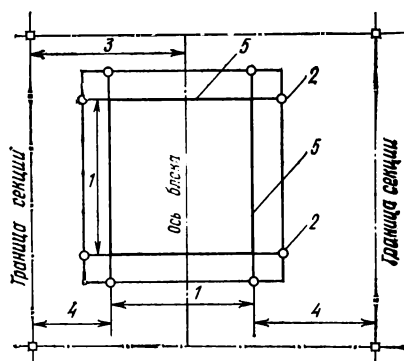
Разбивка осей блоков бетонирования нижнего яруса:
